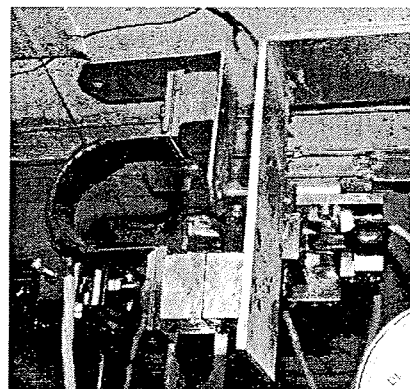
パイゲージによるひび割れ段差計測
